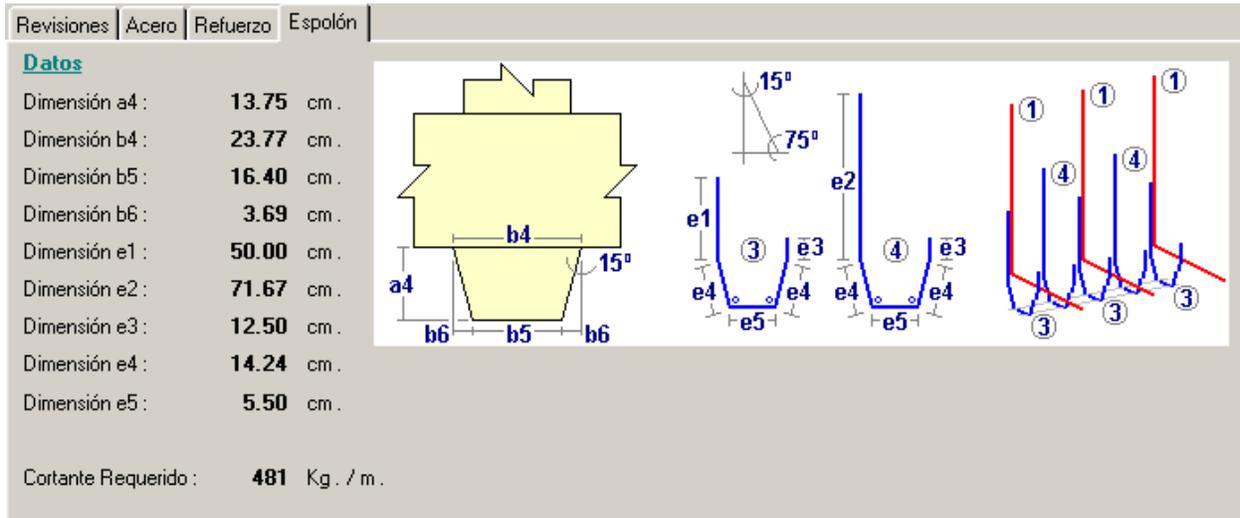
Cálculo de Muro Bajo en "T" sin sobrecarga.
